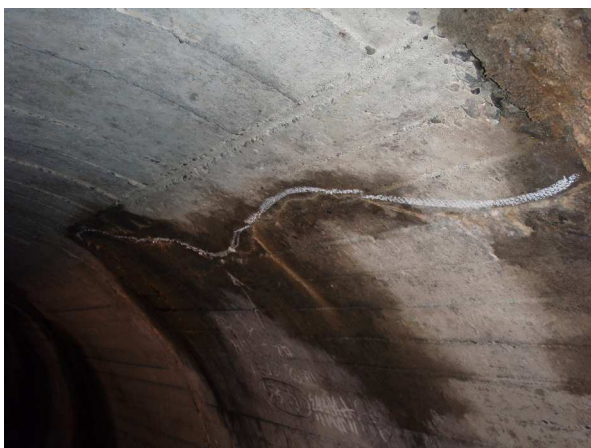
ひび割れからの漏水（滴水）
